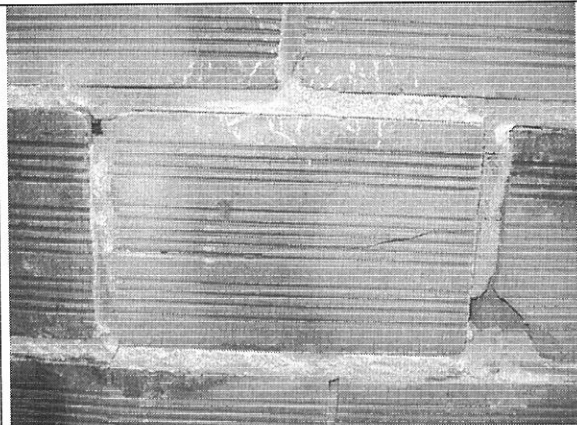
Agrietamiento de unidades de mampostería.
